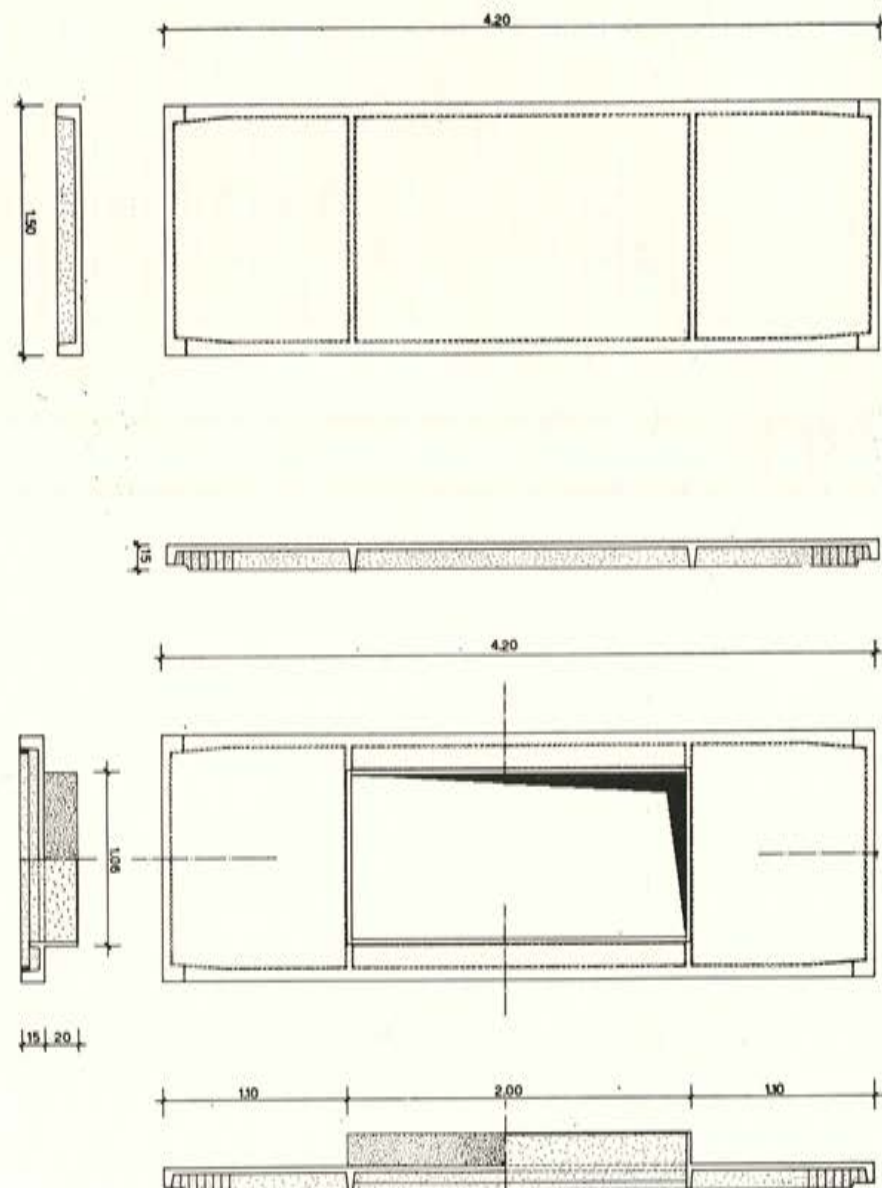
Los dos tipos de placas de cubierta, prefabricadas, en hormigón armado.
